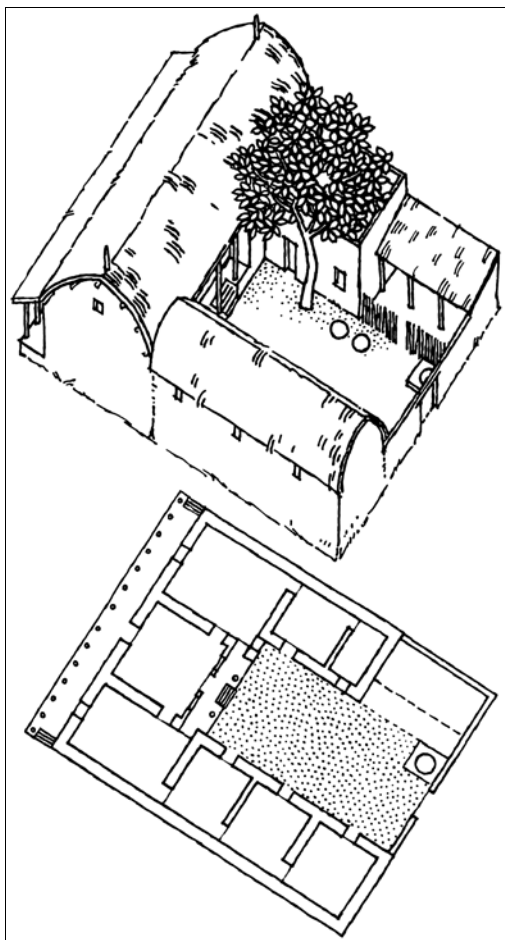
Pianta e alzato di una “casa a corte” tradizionale
